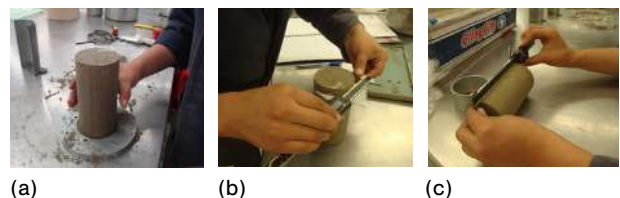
(a) Especimen extraído del molde; (b y c) determinación de dimensiones.
